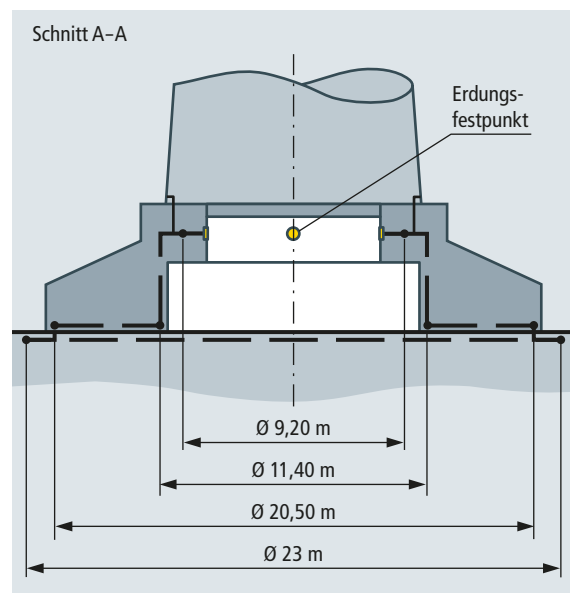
Schnitt eines Fundaments mit Erdungsanlage
